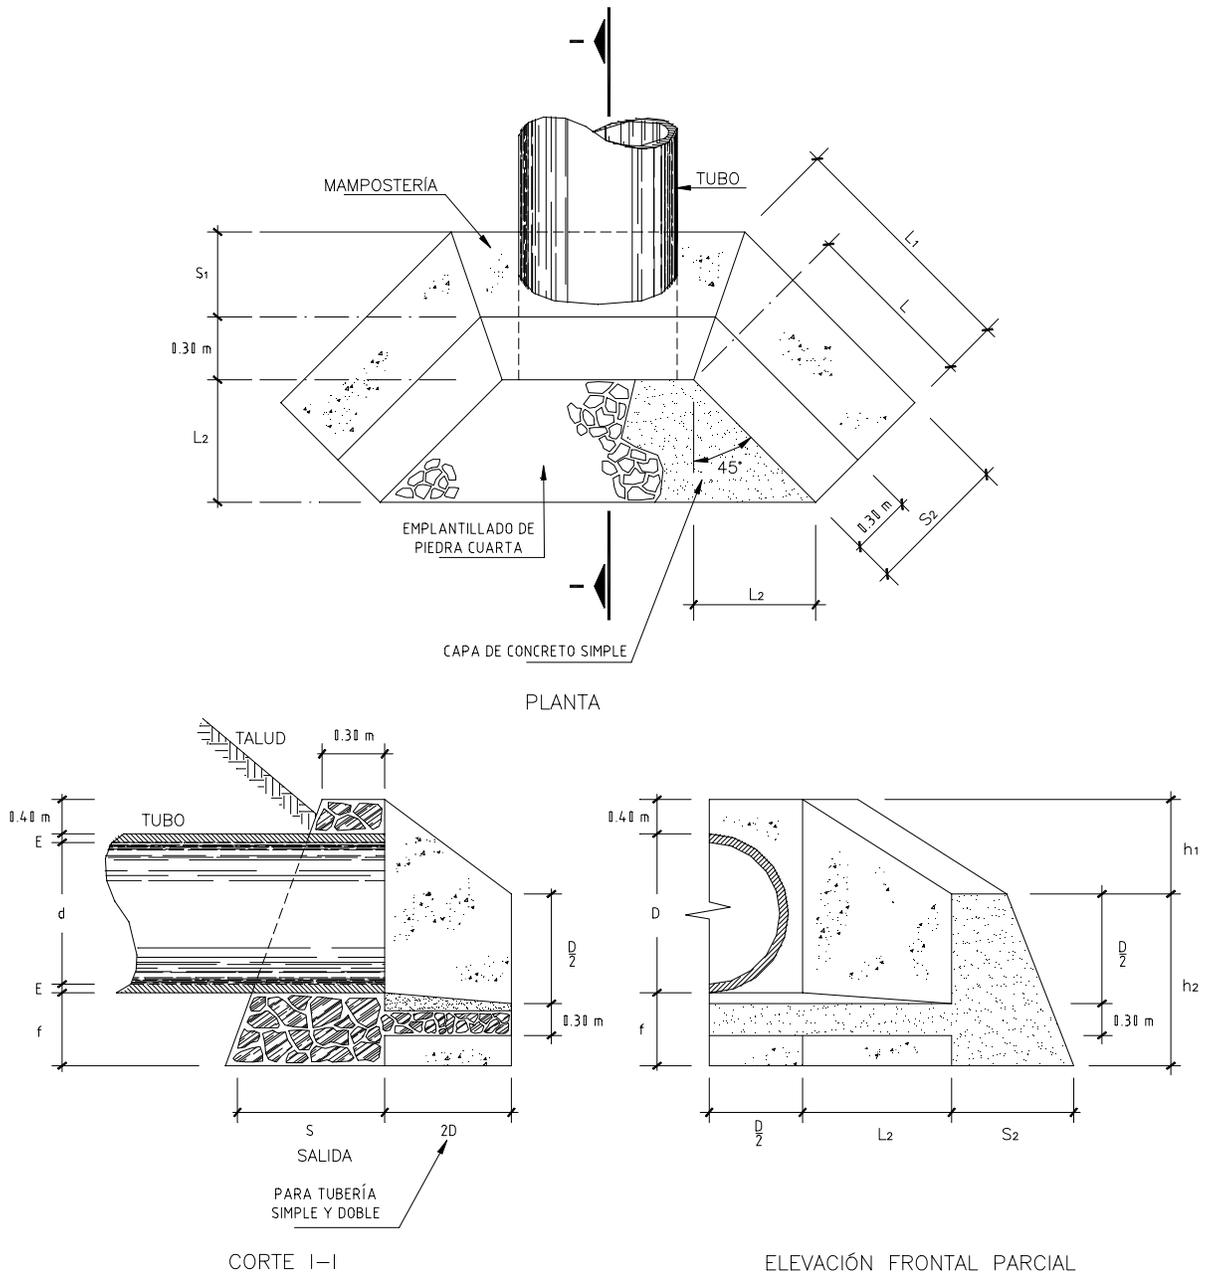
DETALLE DE CABEZAL TIPO "B" EN PLANTA Y PERFIL.
